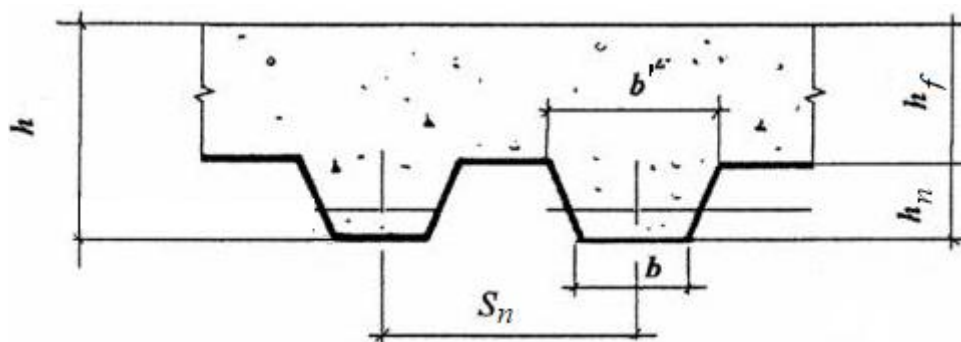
Поперечное сечение сталежелезобетонной плиты
